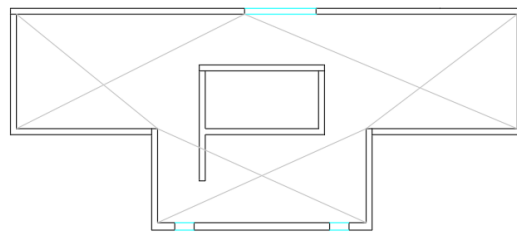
Adaptación de plano estructural de planta del piso 17.
